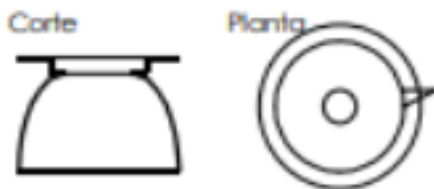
PLANTA Y ALZADO DE HABITAT EXCAVADO EN CHINA, CONOCIDO COMO VIVIENDA EN SACO, NEOLITICO.
